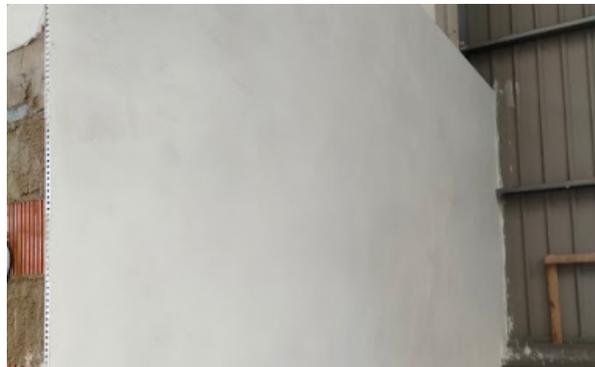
Colocación de la perfilería para la realización de trasdosados de placa de yeso laminado en las oficinas existentes en planta baja.
